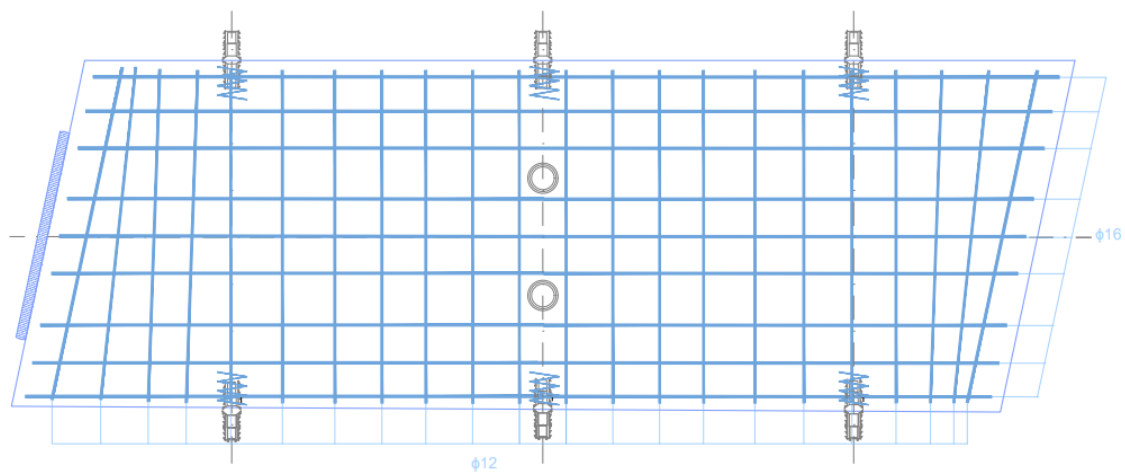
Plano Dovela – Armadura Vista Superior
